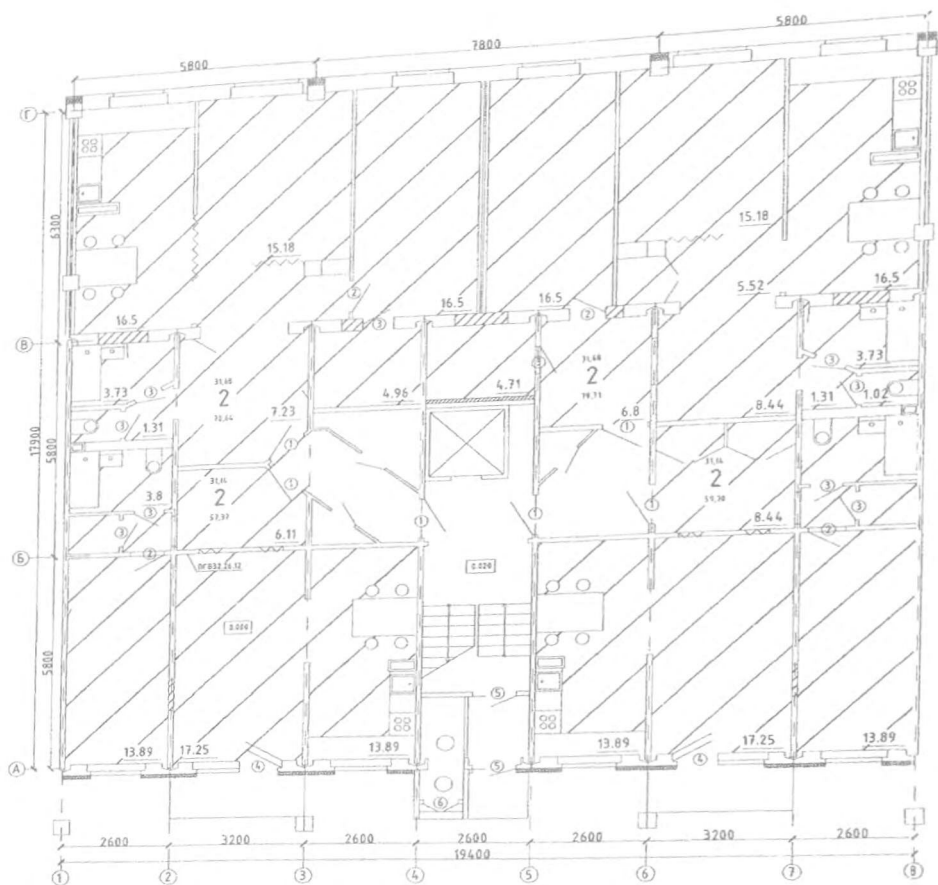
План рядовой секции дома в пределах 1 – 5 этажей после реконструкции
